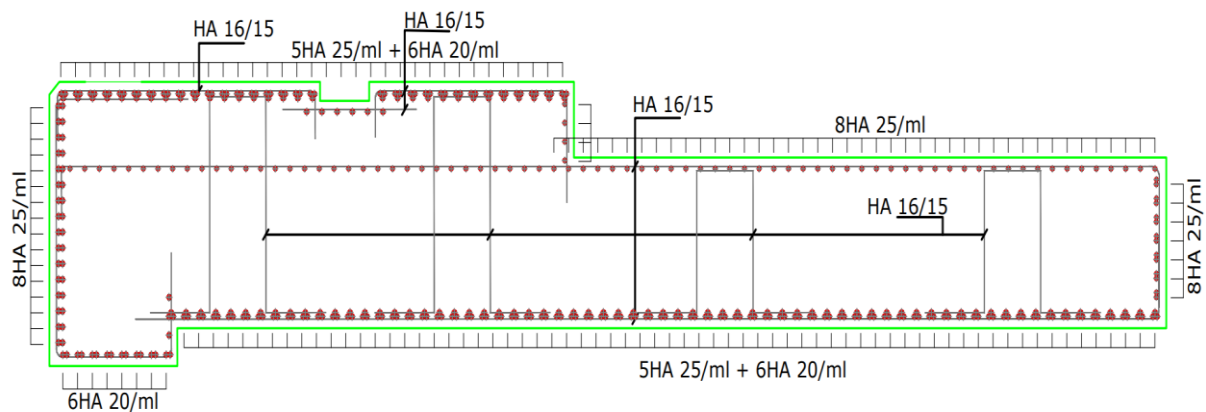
Plan de ferrailage de la poutre de couronnement
